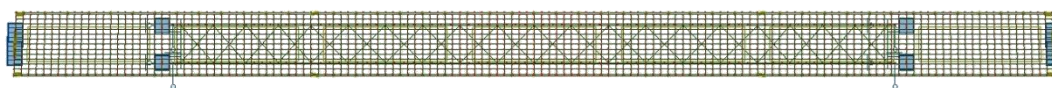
Planta da ponte com representação da malha de elementos finitos da laje
